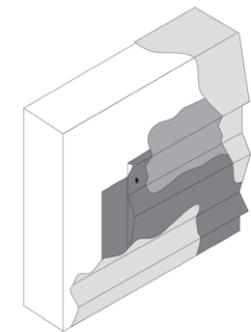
Detalle de re impermeabilización de encuentro con paramento vertical
